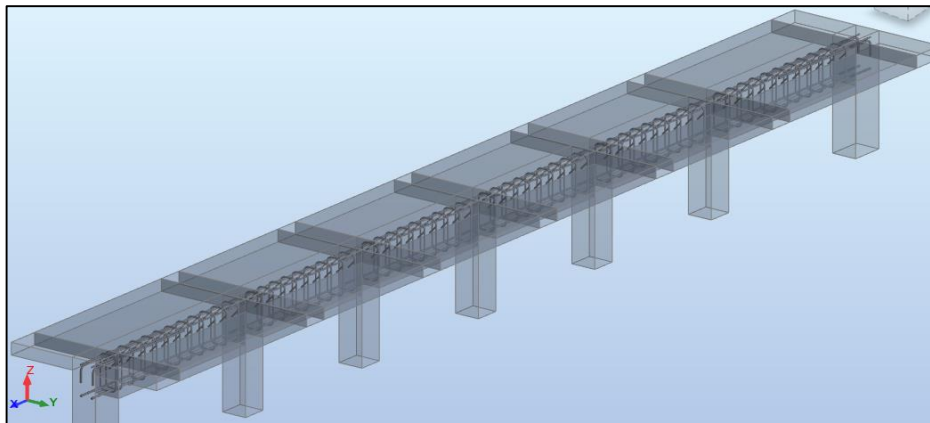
Disposición final de los aceros en el modelo tridimensional del tramo VN01-01 de la losa nervada -01.
